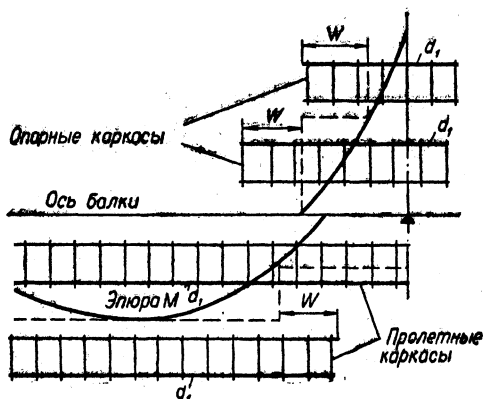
Схема обрывов сварных каркасов в пролете неразрезной балки.
